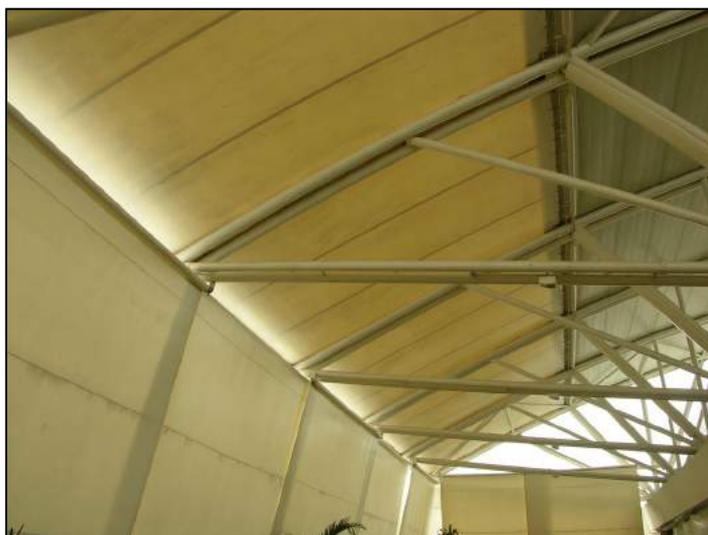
Fechamento do Terraço com lonas descaracterizando o projeto
